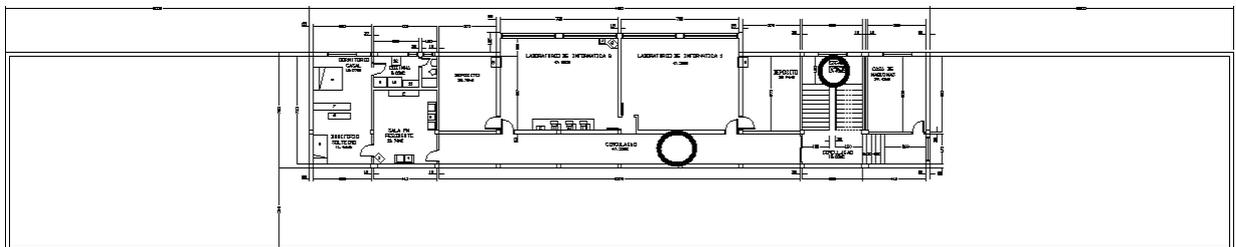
Disposição recomendada dos pontos de luz para o quinto pavimento.
